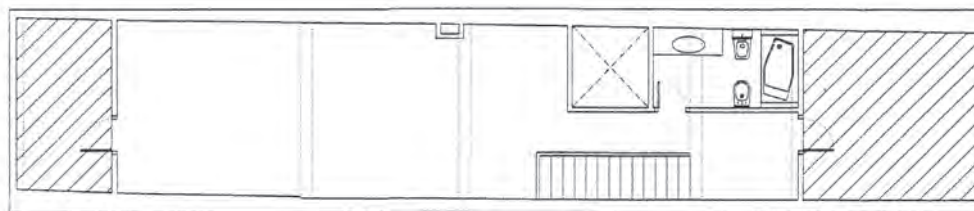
16. 1995 PLANTA BAJOCUBIERTA REFORMADA (DUPLEX)
